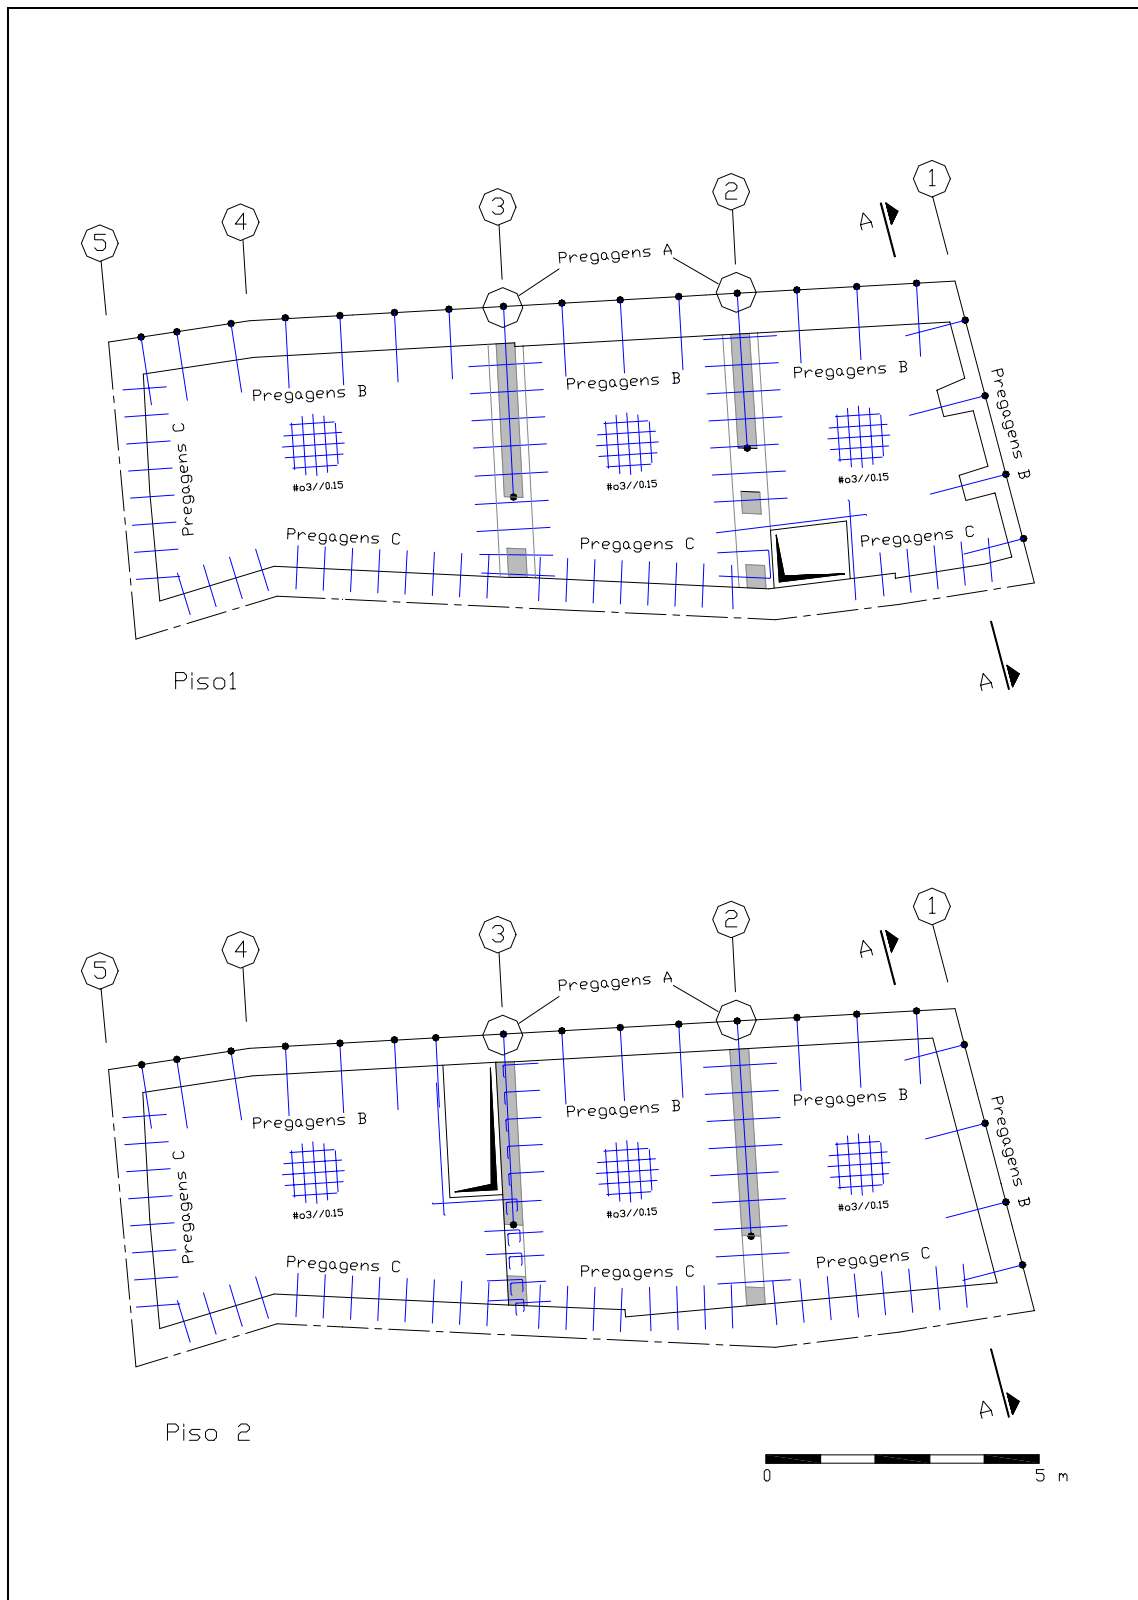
Rigidez dos pavimentos com camada de betão armado. Armaduras e pregagens com as paredes.
